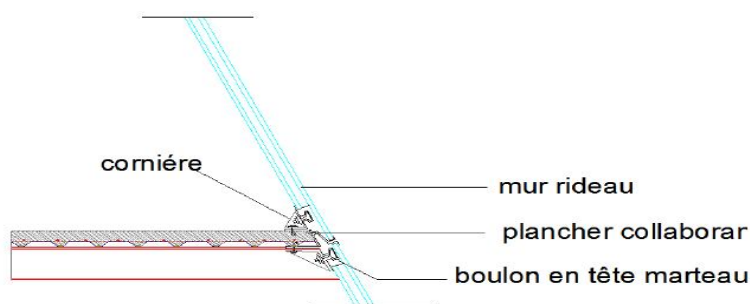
& 82: Fixation du mur rideau incliné sur un plancher collaborant.
